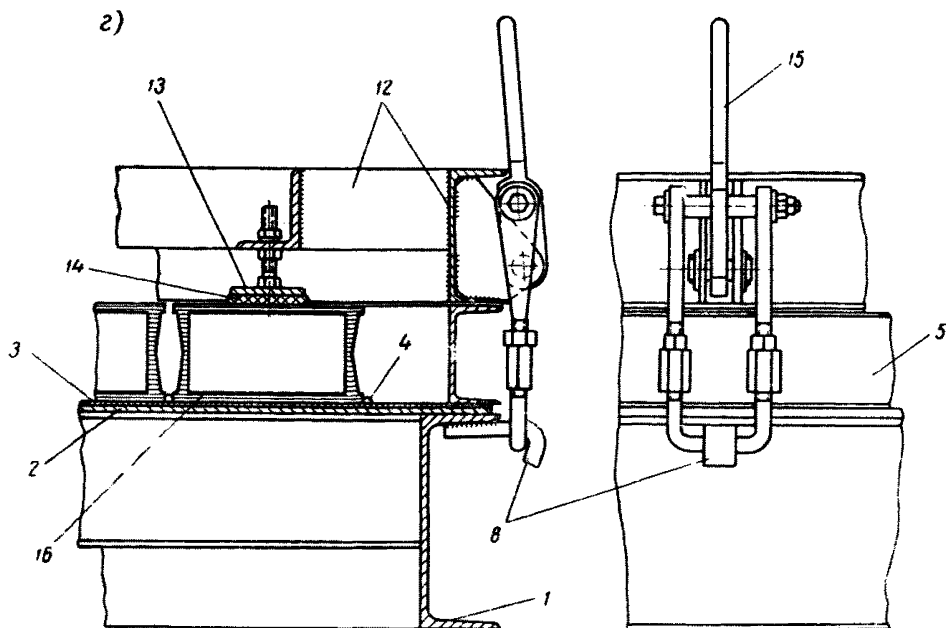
Схема устройства металлической опалубочной формы с прижимной рамой
